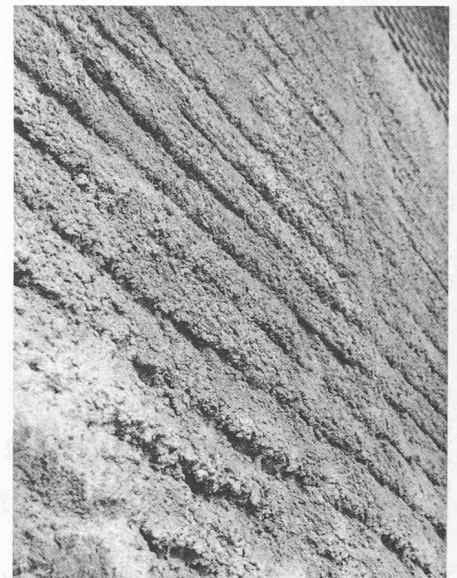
Mit Spritzbeton ungenügend überdeckte Armierungsdrähte
